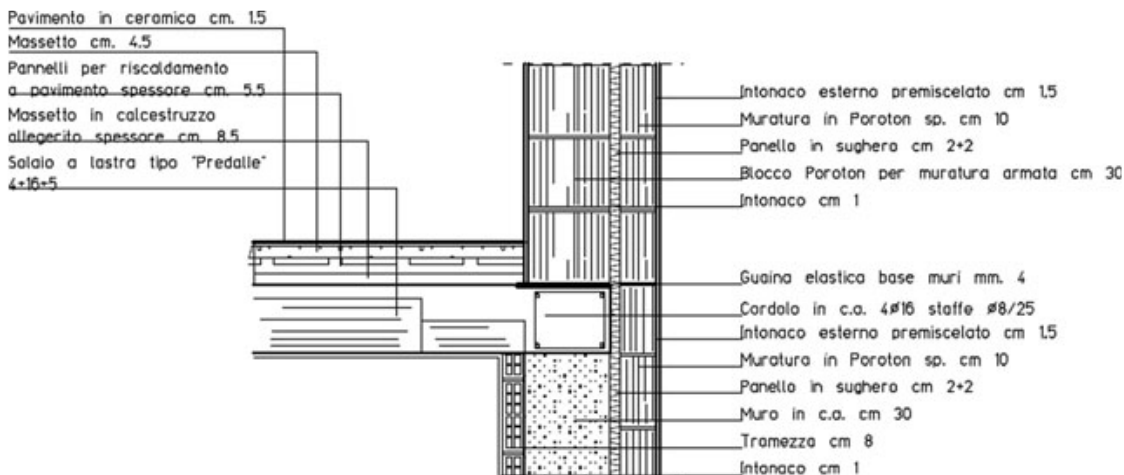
Particolare costruttivo del nodo muratura solaio del piano autorimessa.
